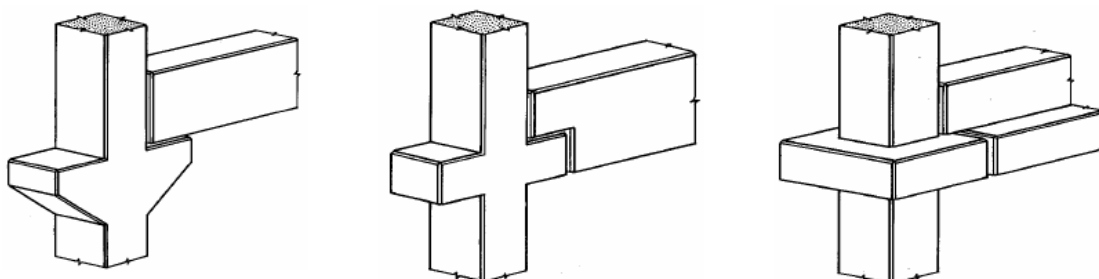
Vigas de secção retangular endentadas (FIB, 2002)
